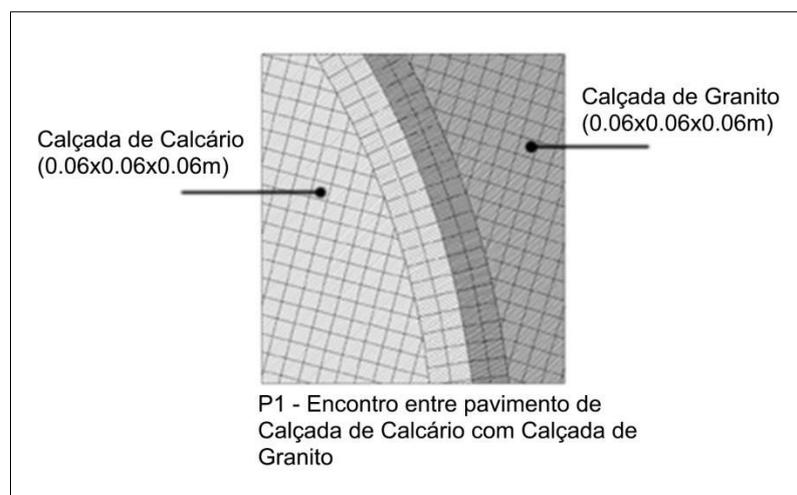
Exemplo de pormenor de estereotomia de pavimento, dum projeto, escolhido aleatoriamente. O P1 (Pormenor 1) está de acordo com o corte identificado no local correto, na planta de pavimentos
